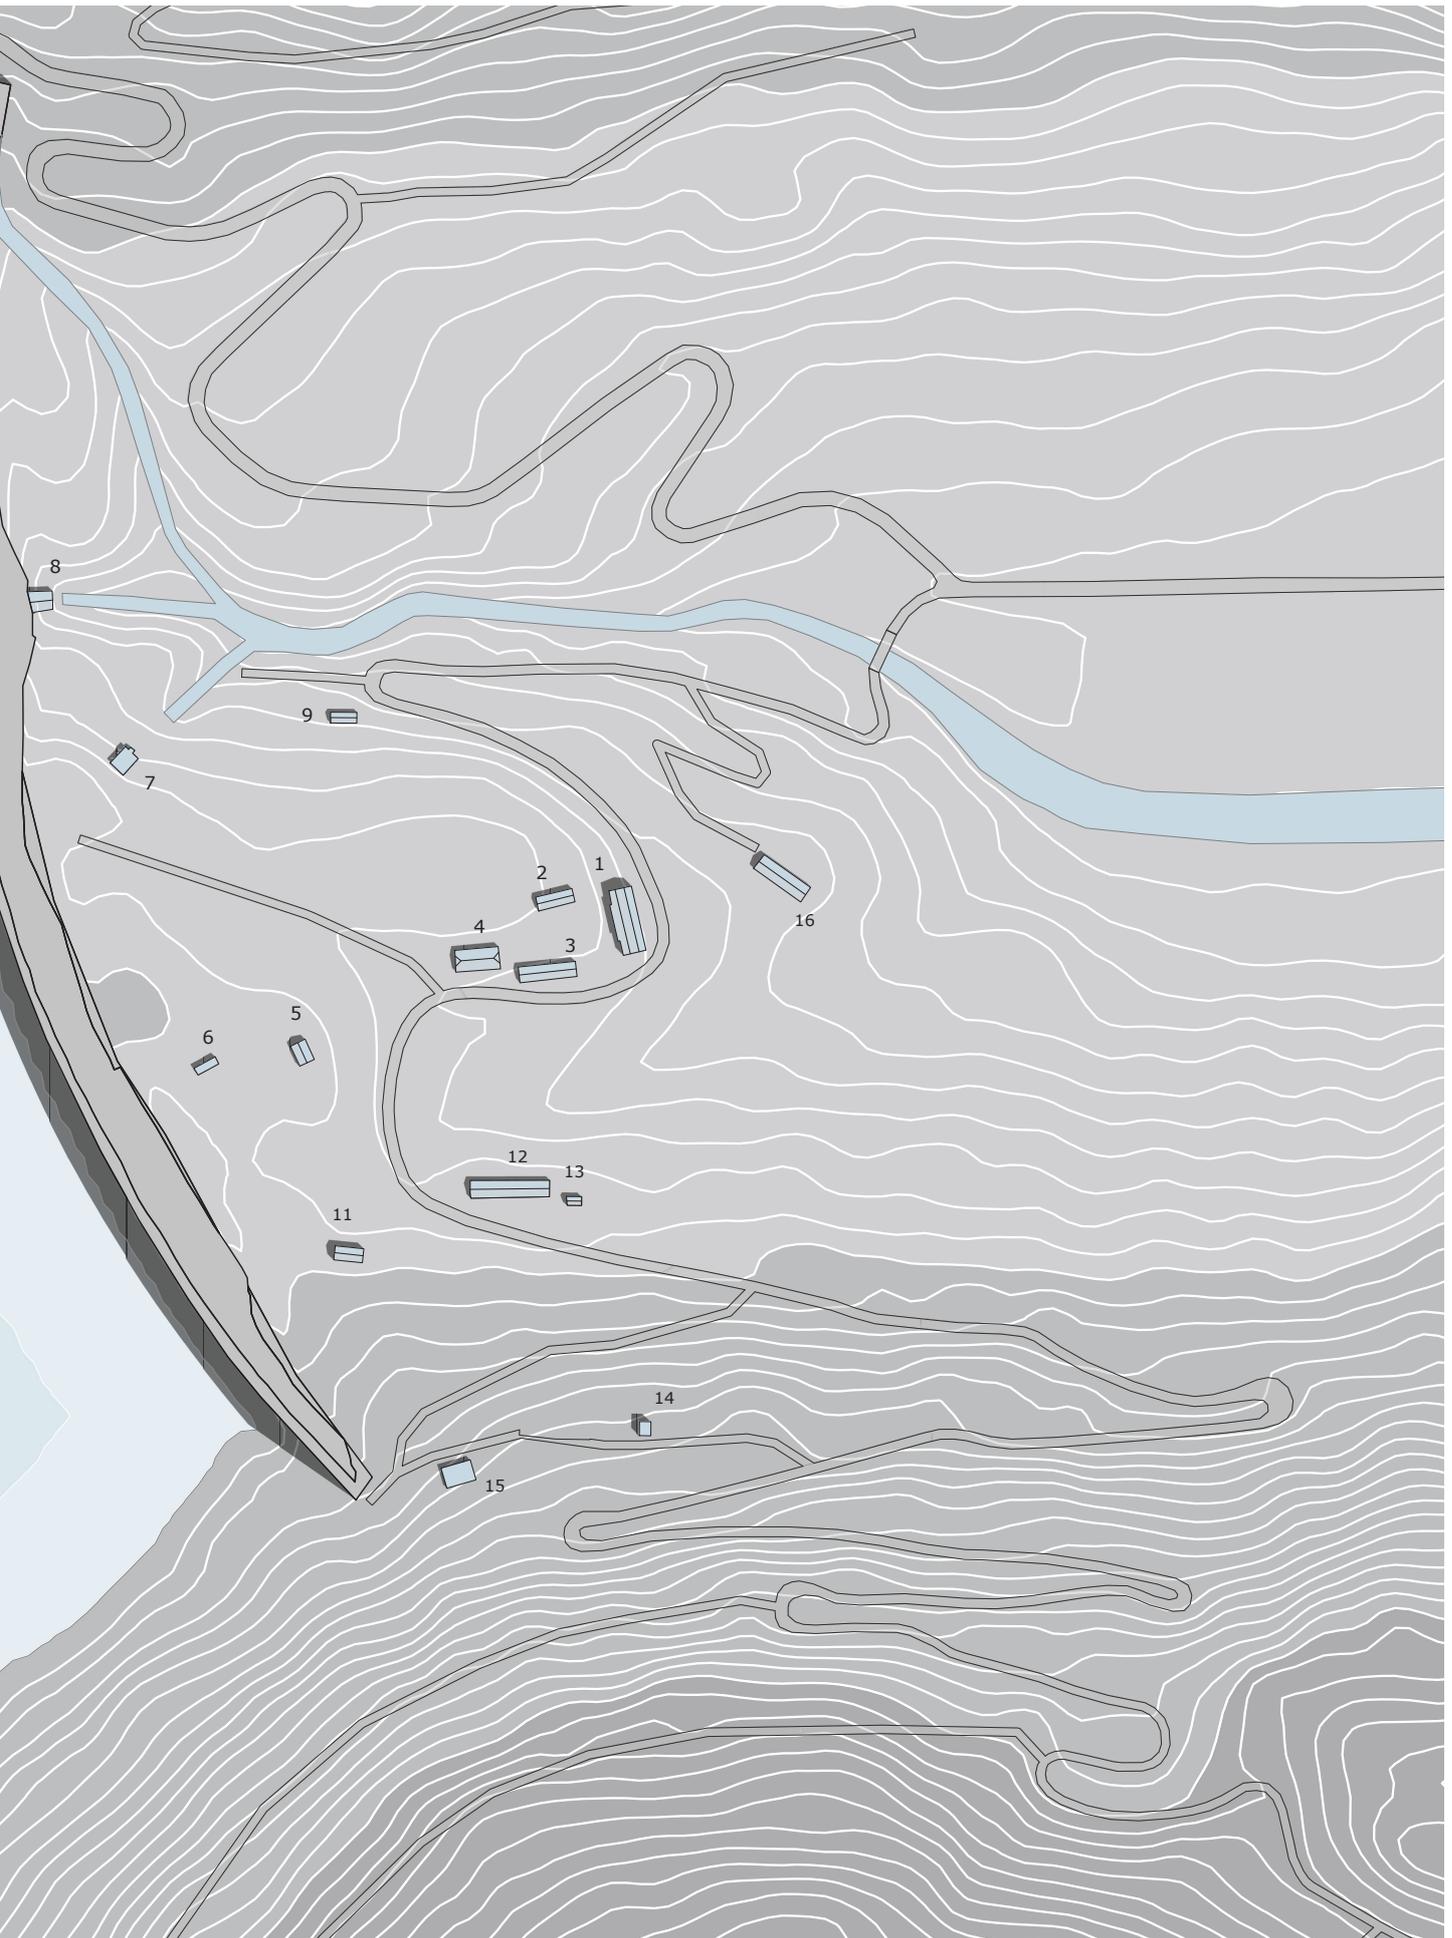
Planimetria stato di fatto area di progetto - scala 1:3000
